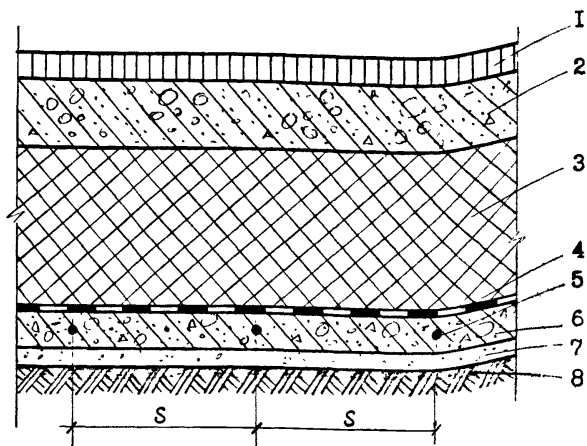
Конструктивная схема пола с электрообогревом при помощи стержневых нагревателей. 1 - покрытие пола; 2 - подстилающий слой; 3 - теплоизоляция; 4 - гидропароизрляия; 5 - стержни-нагреватели; 6 - обогревающая бетонная плита; 7 - бетонная подготовка; 8 - грунт основания, уплотненный щебнем или гравием.
